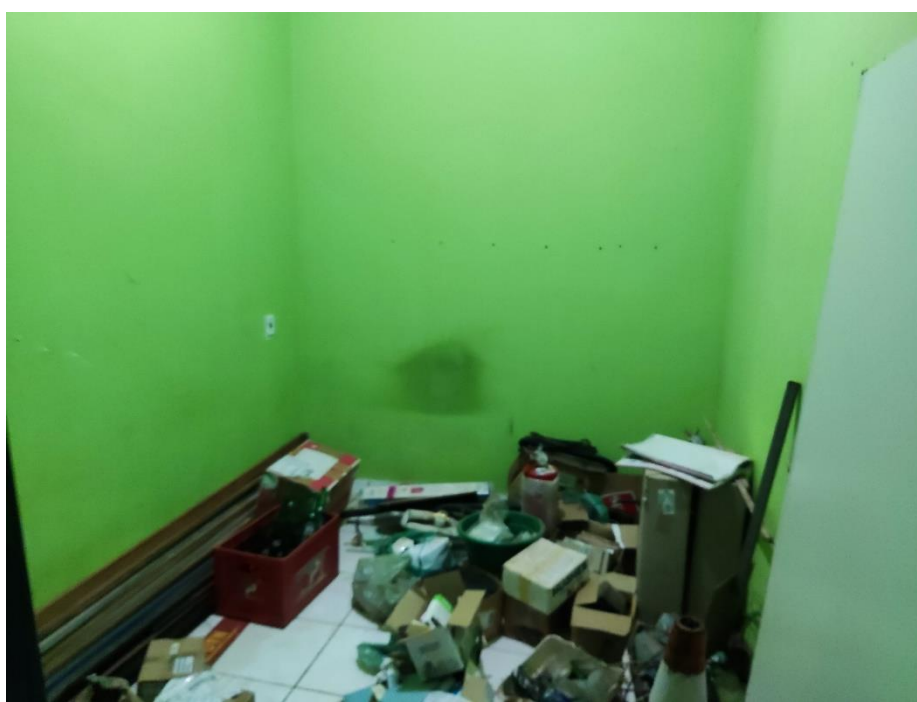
Prédio para locação em Paranatinga – Sala arquivo. Foto em 14/03/2024.
